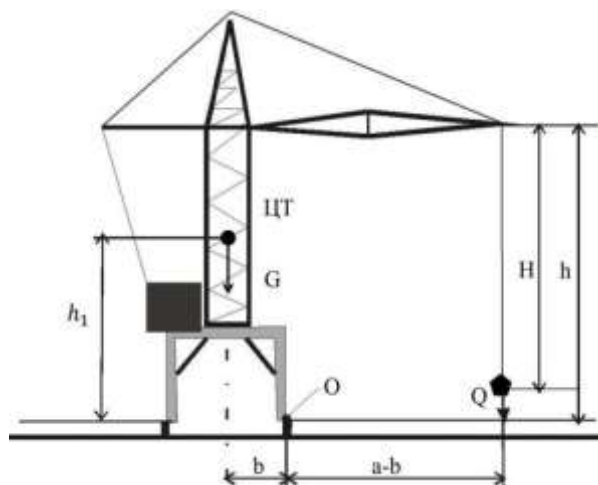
Расчетная схема грузовой устойчивости башенного крана
